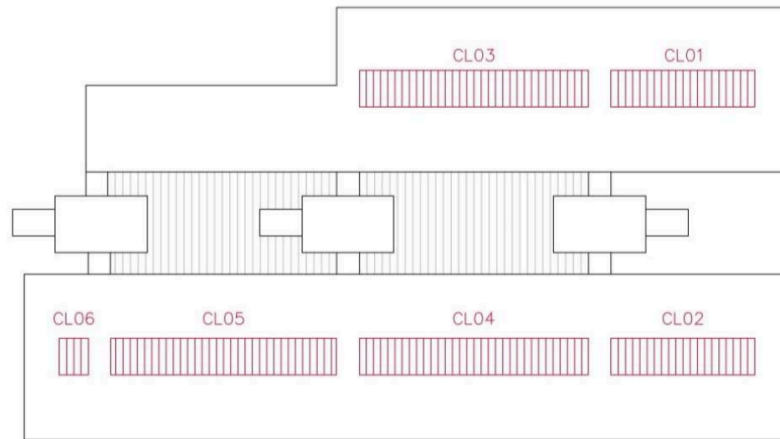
Planta da cobertura do Pavilhão de Civil com claraboias numeradas
